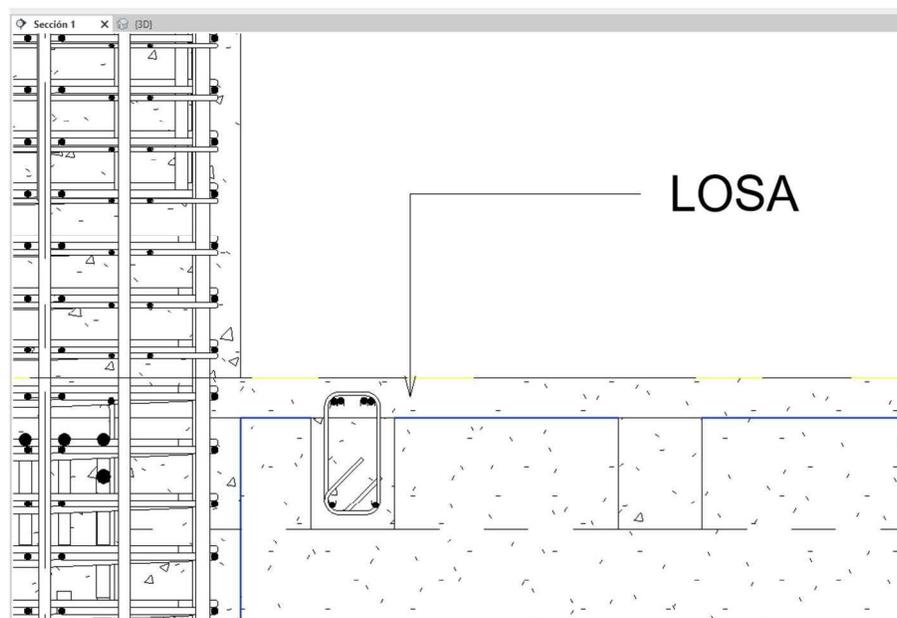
Ir a vista de sección de los nervios para colocar el acero de refuerzo
